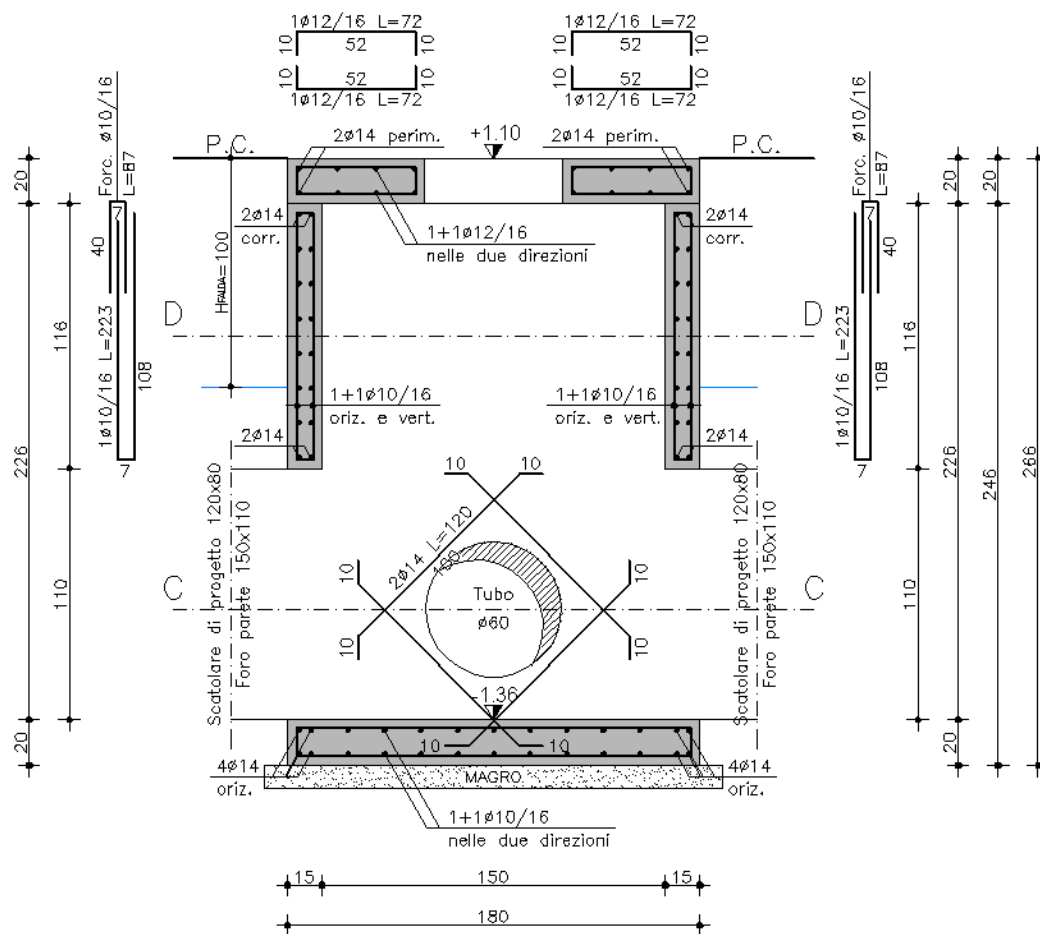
Pozzetto n. 2 - Sezione verticale A-A
